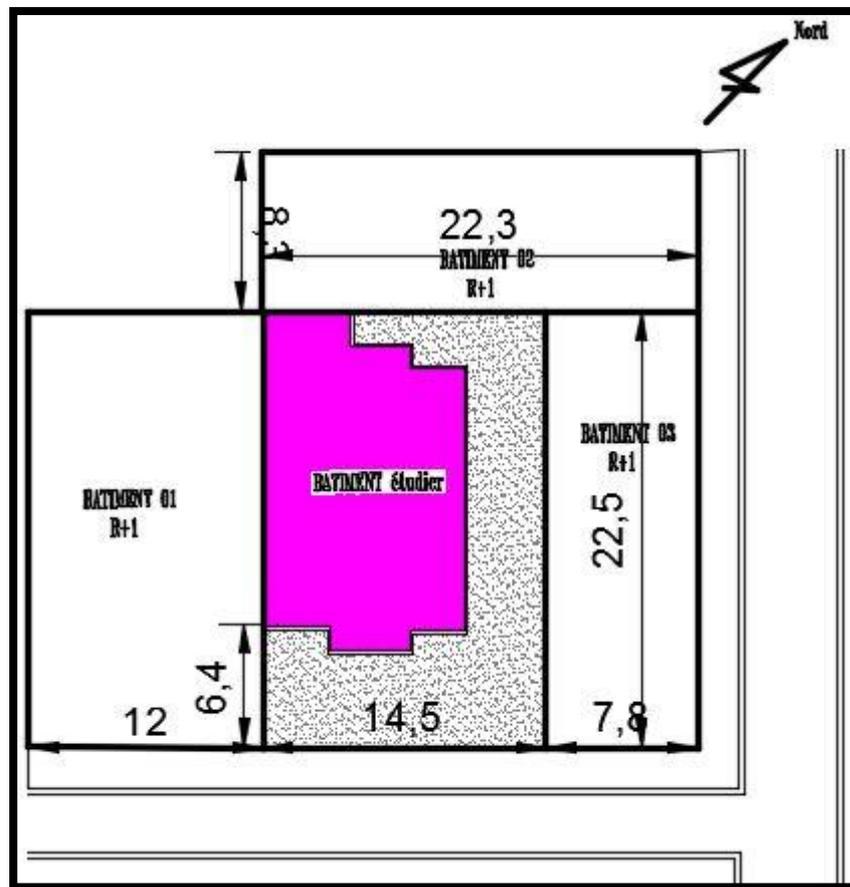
Plan de masse du bâtiment cas d'étude, échelle 1/100
